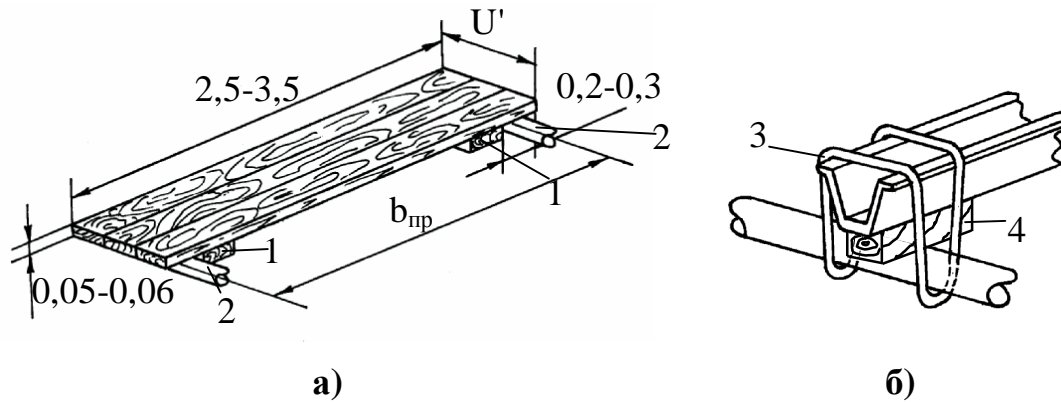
Конструкція дерев'яного помосту перекриття (а) тимчасового випереджального кріплення з прогоном із труби (б): 1 – стяжний відрізок дерев'яного бруса; 2 - труба; 3 – фігурна скоба; 4 – клин дерев'яний
